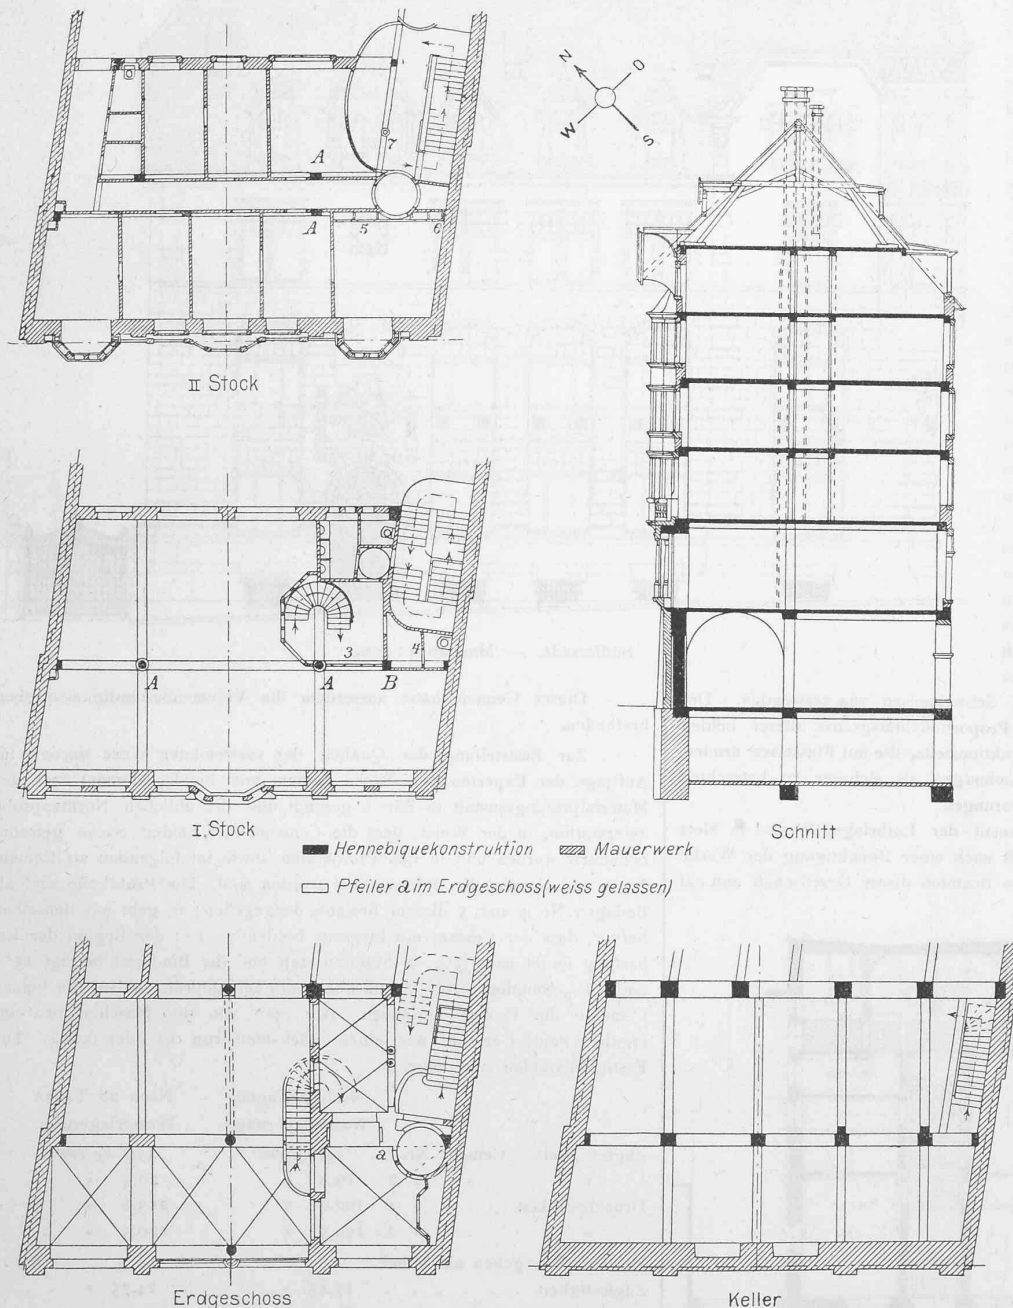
Das Vordergebäude des «Restaurant und Hotel zum Bären». — Grundrisse und Schnitt. — Masstab 1 : 300.
